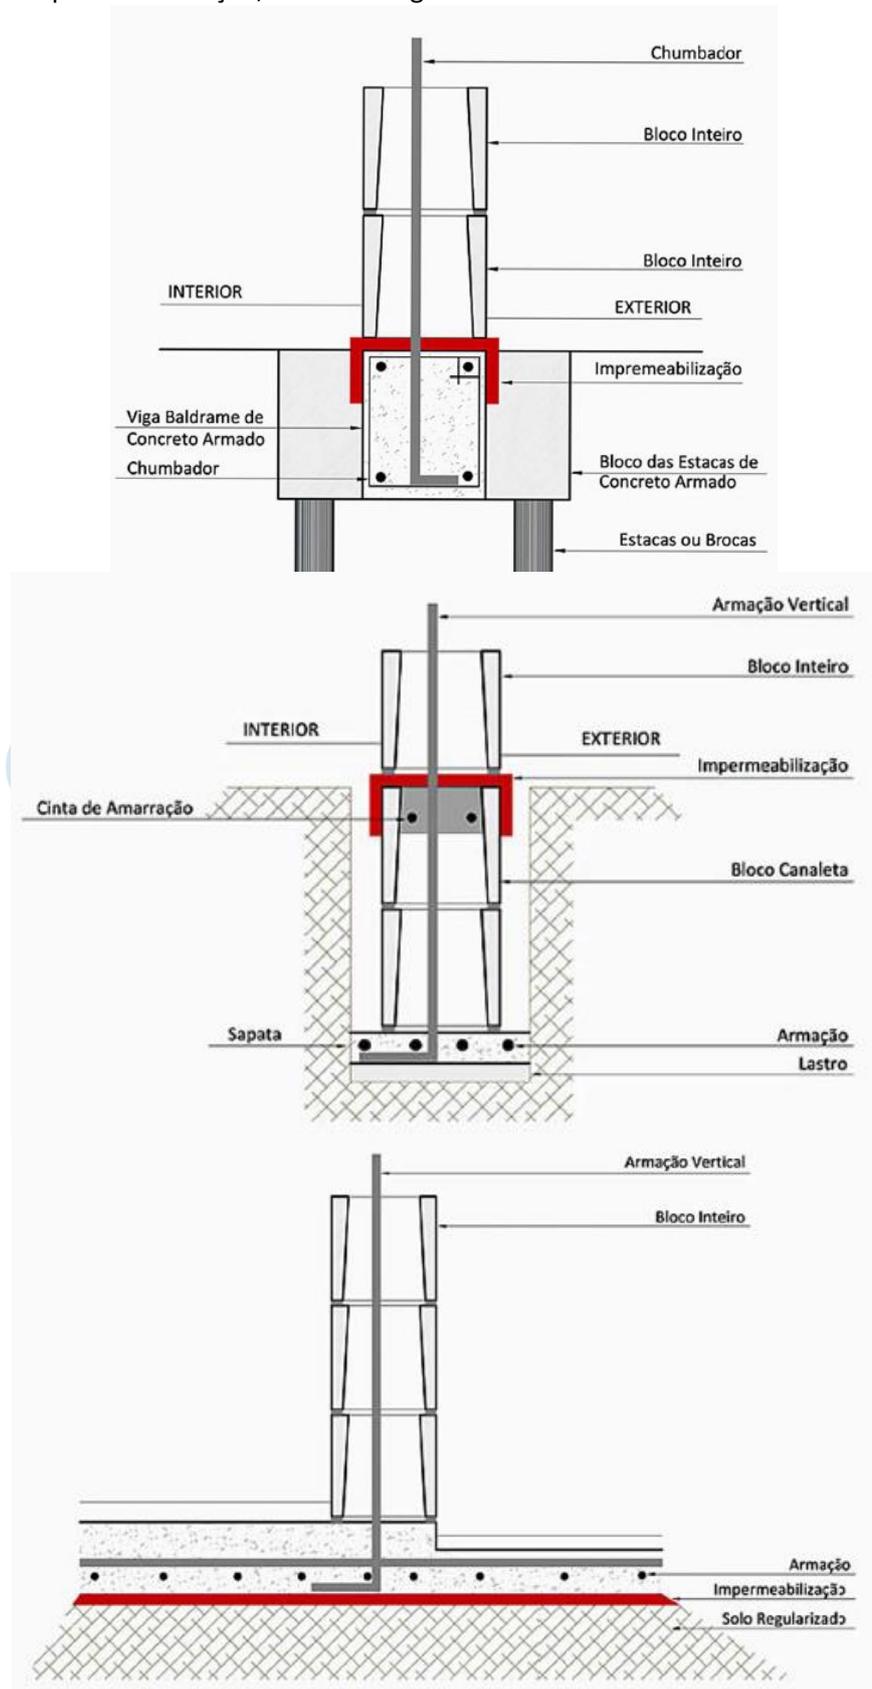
Fixação da espera da armadura vertical em bloco de fundação/viga baldrame, sapata e radier
